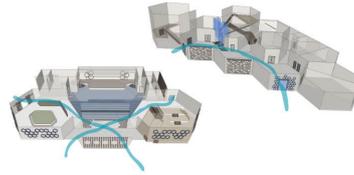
Penerapan *Ventilation Cooling* pada desain
